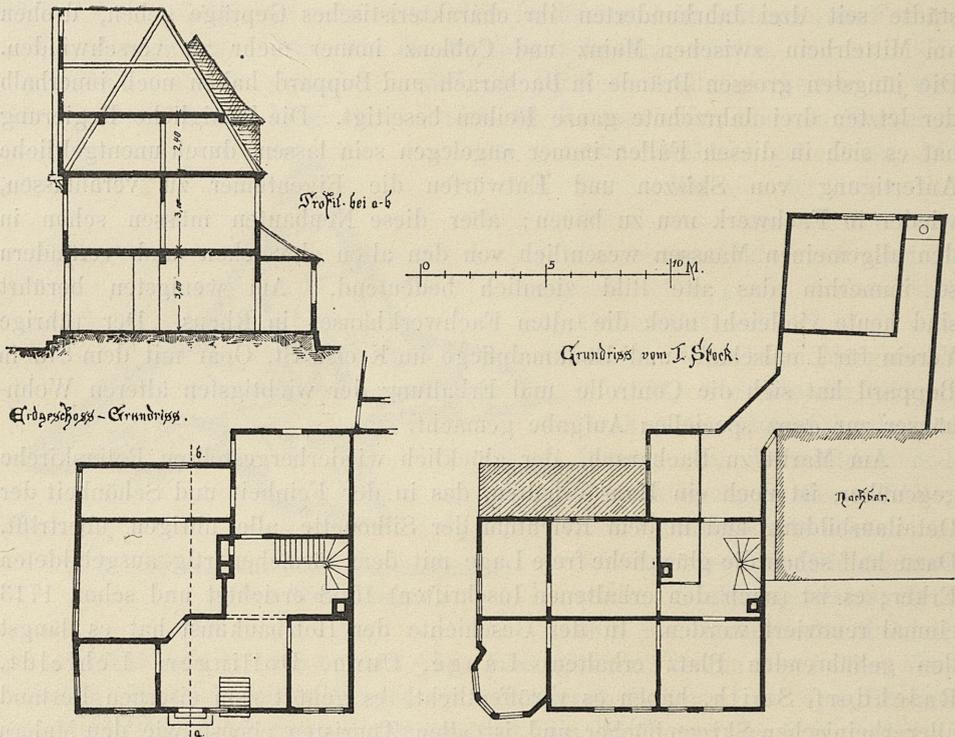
Bacharach, Altes Holzhaus. Grundrisse und Querschnitt.
